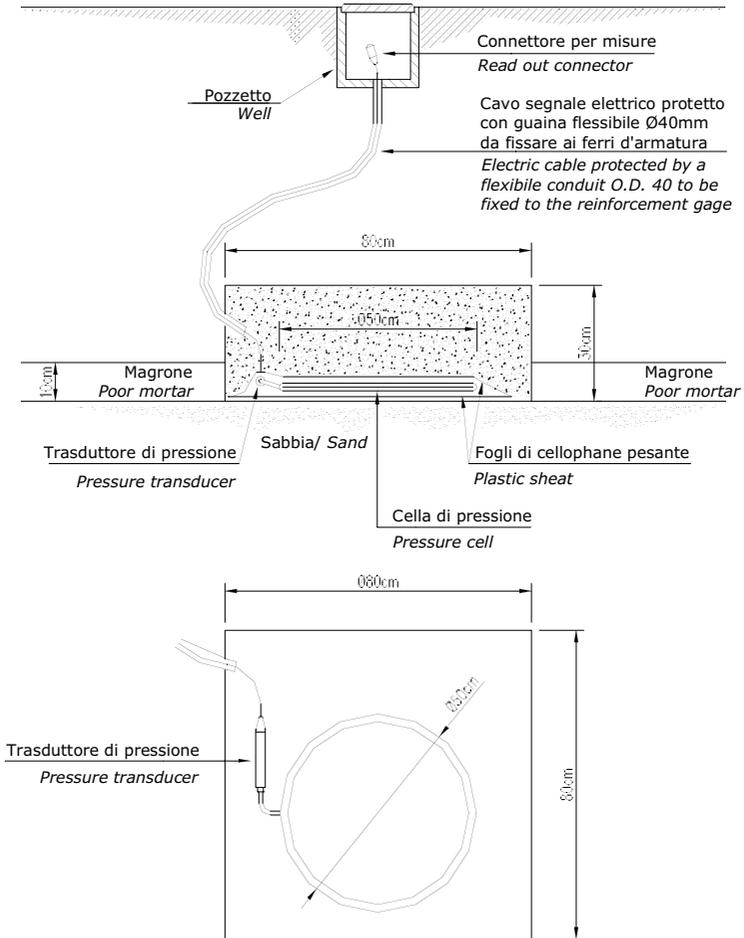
Schema di installazione orizzontale cella di pressione Ø 50cm
